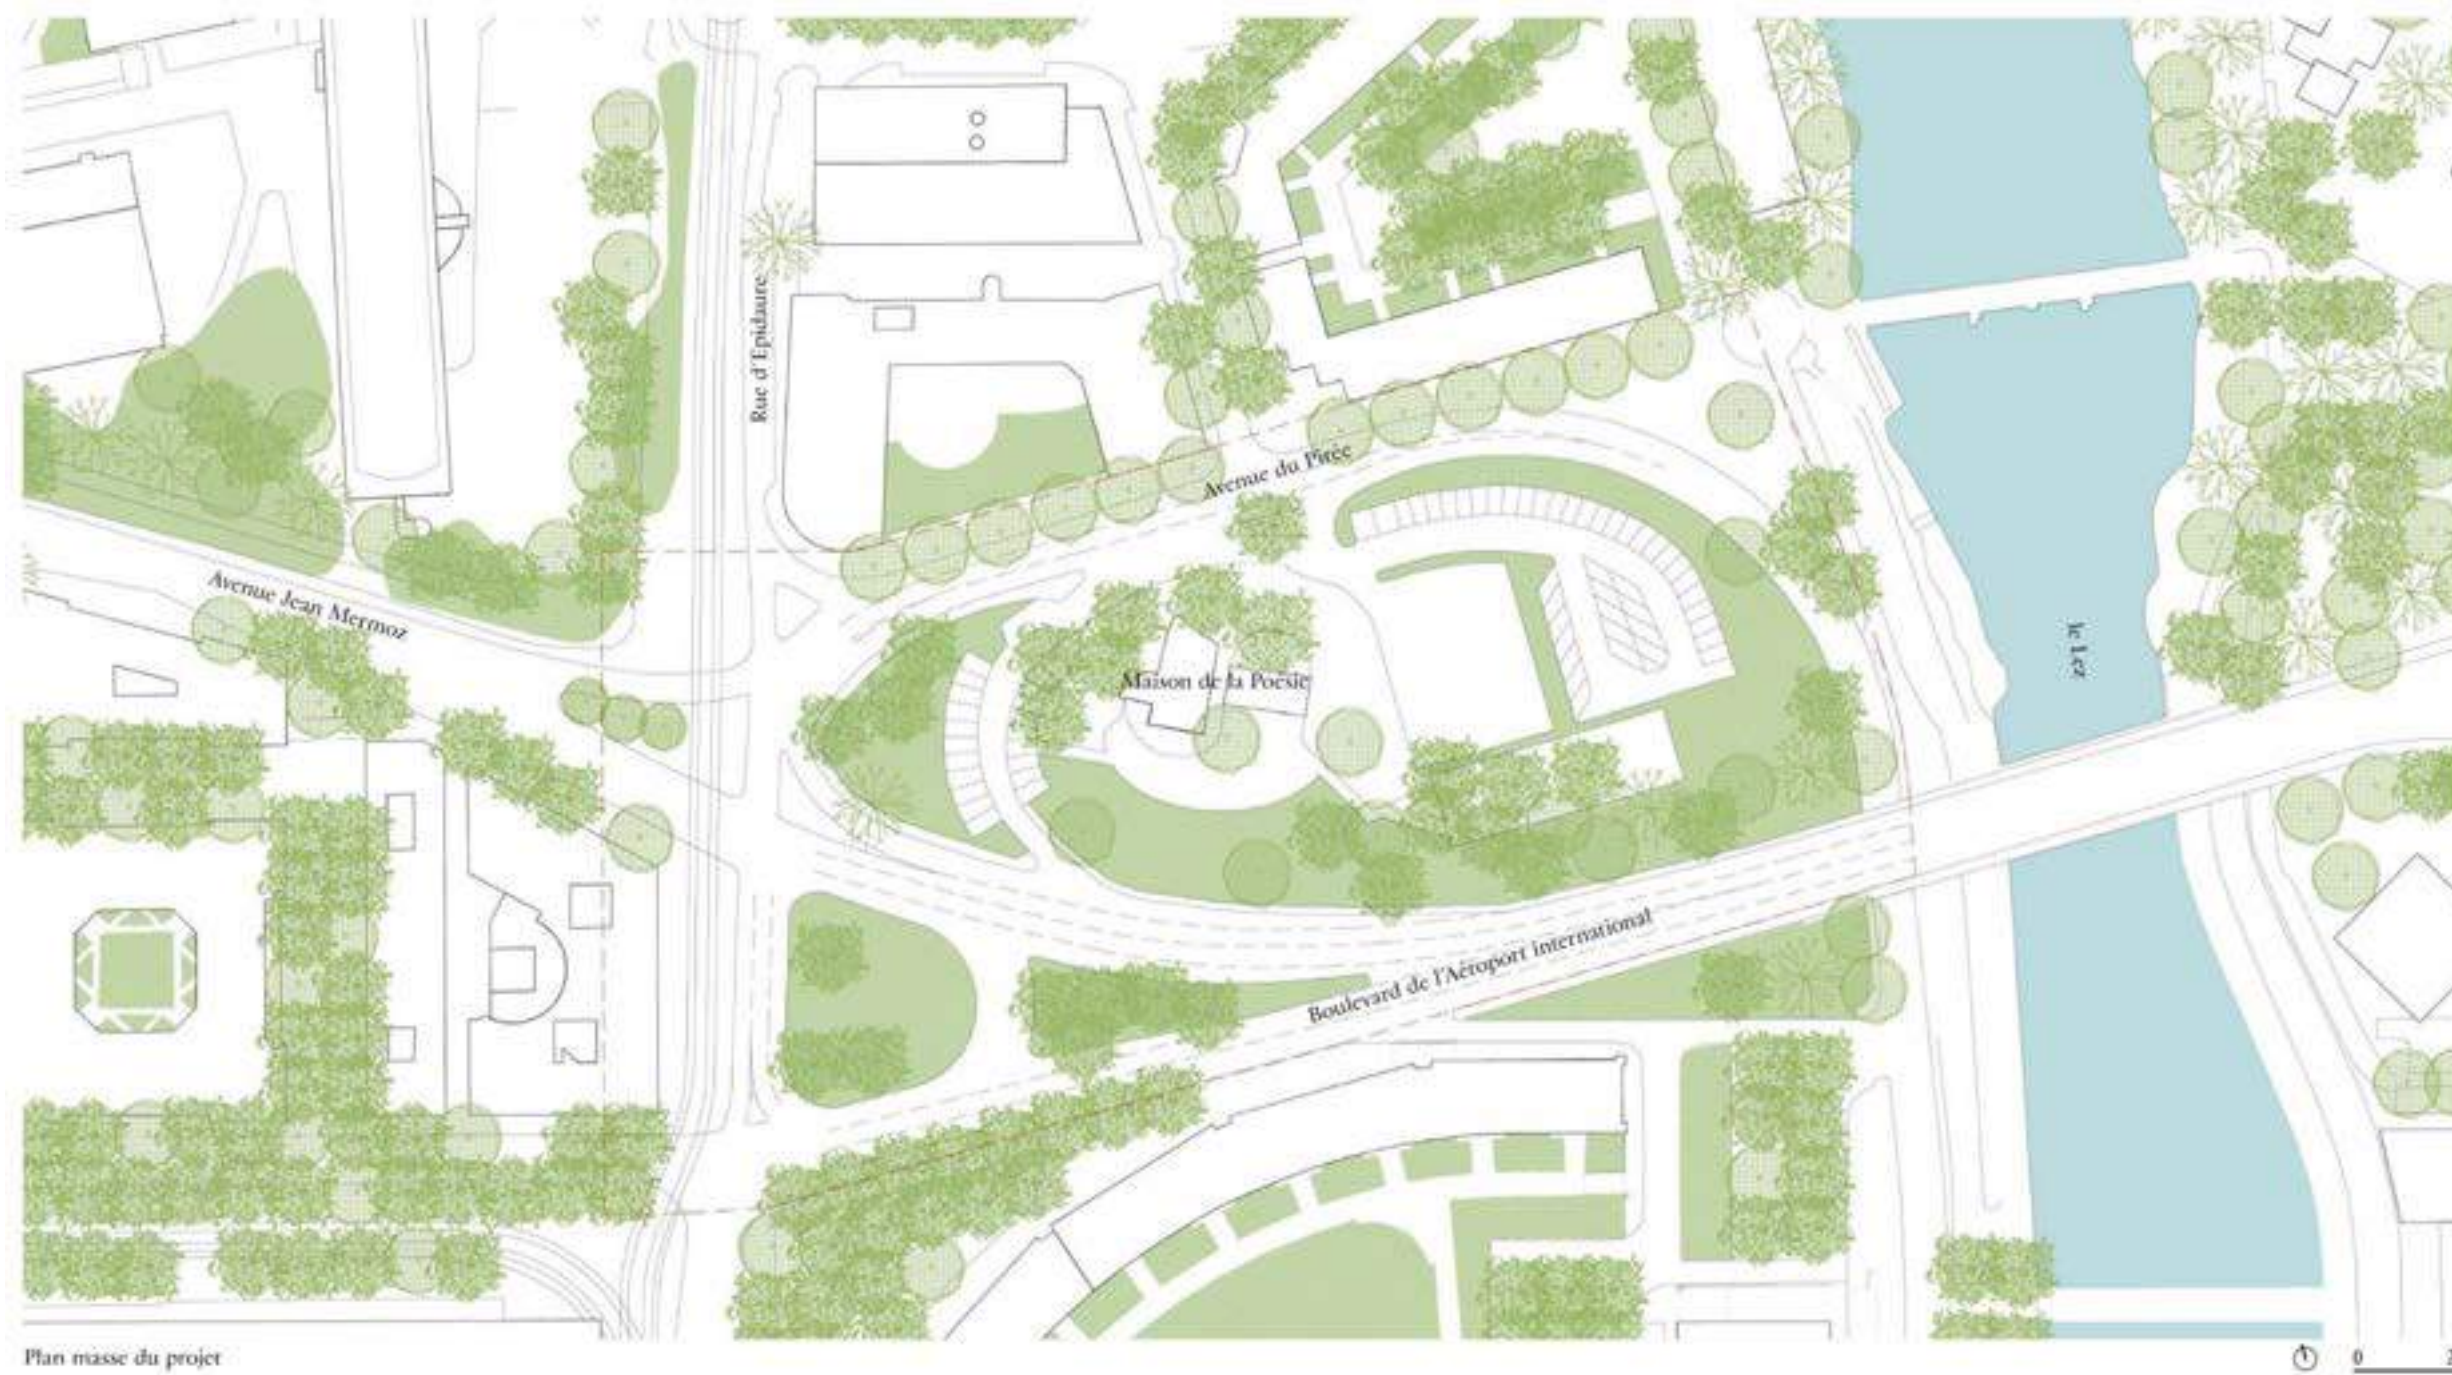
Plan masse existant I lot de la Maison de la Poésie
